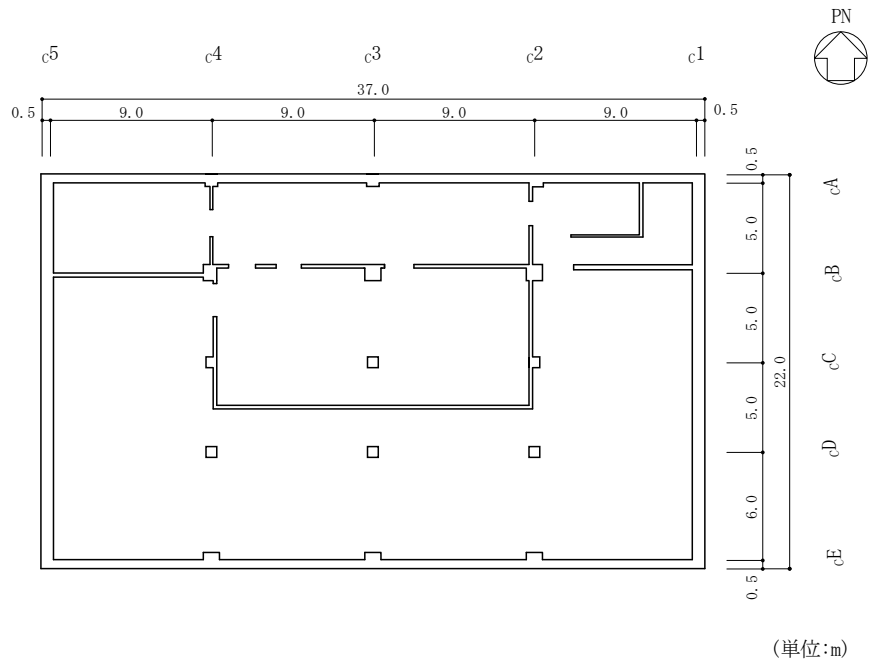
(3) 制御室建物の概略平面図 (EL 12.8m)
